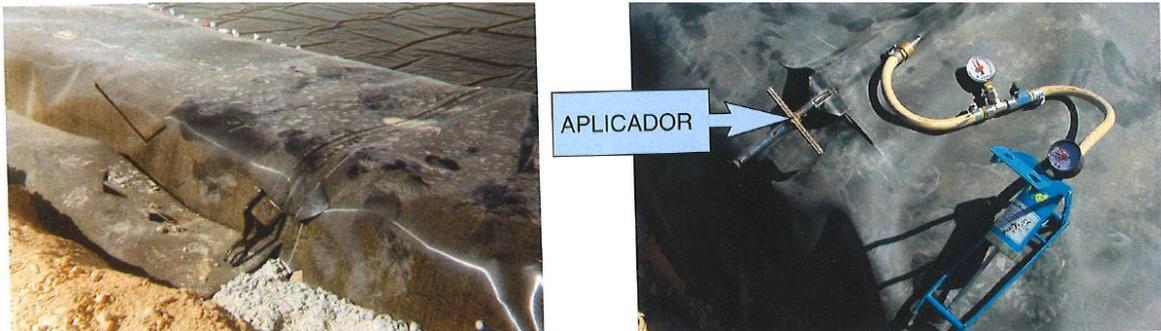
Cierre del extremo de la soldadura, bomba y aplicador.
